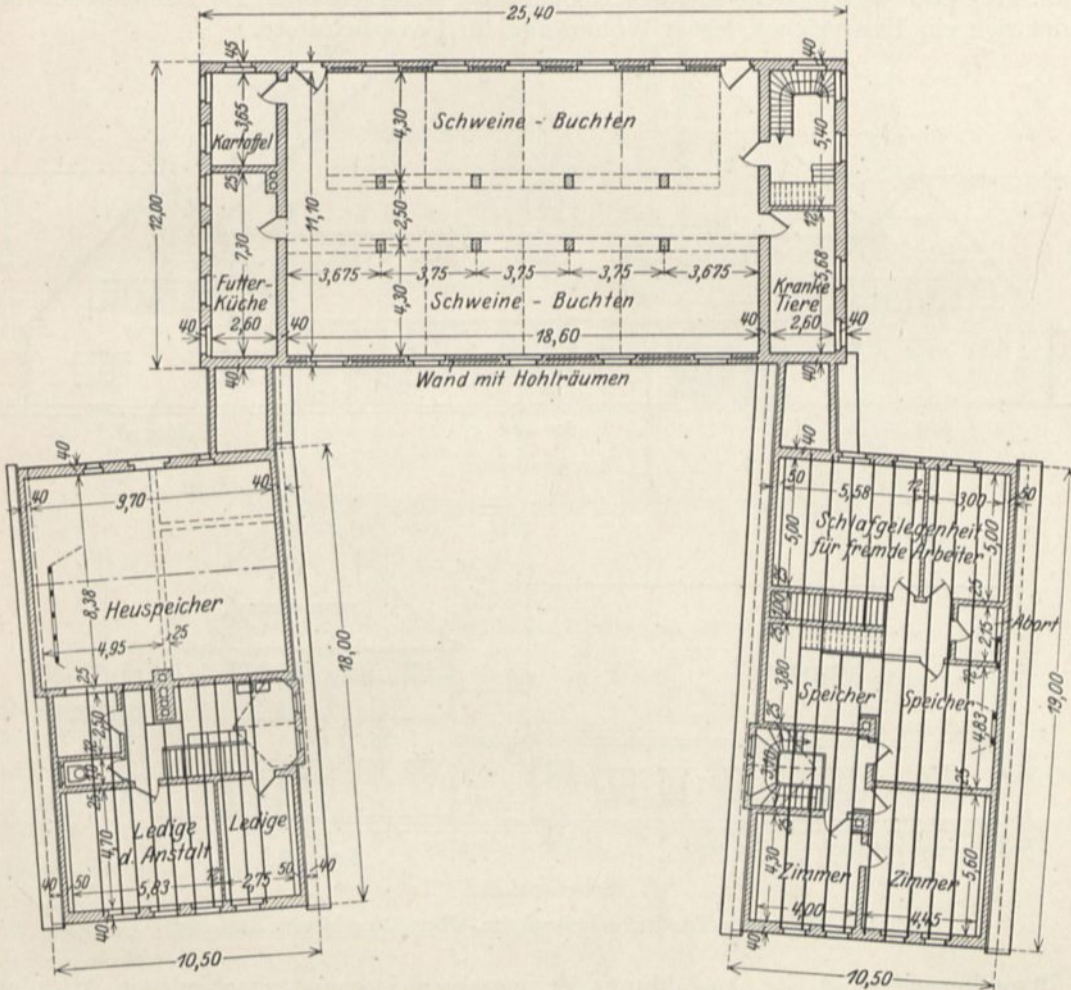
Heilstätte Friedrichs-Luisenheim. Ökonomiegebäude. Ober- bzw. Dachgeschoßgrundriß.
